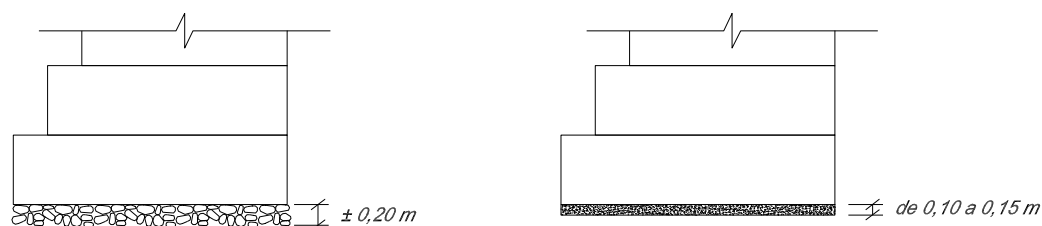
Detalhe da preparação do terreno na cota de apoio da estrutura.
